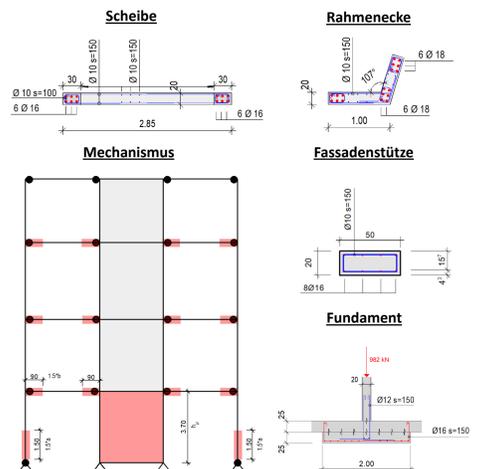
Mechanismus (u.l.) mit konstruktiven Details (Allplan 2019).
